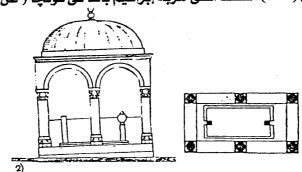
مسقط افقى لتربة خاصكى حرم بمجمع السليمانية باستانبول (عن : اصلان ابا)
